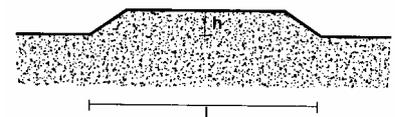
DIMENSIONES BADÉN TRAPEZOIDAL
